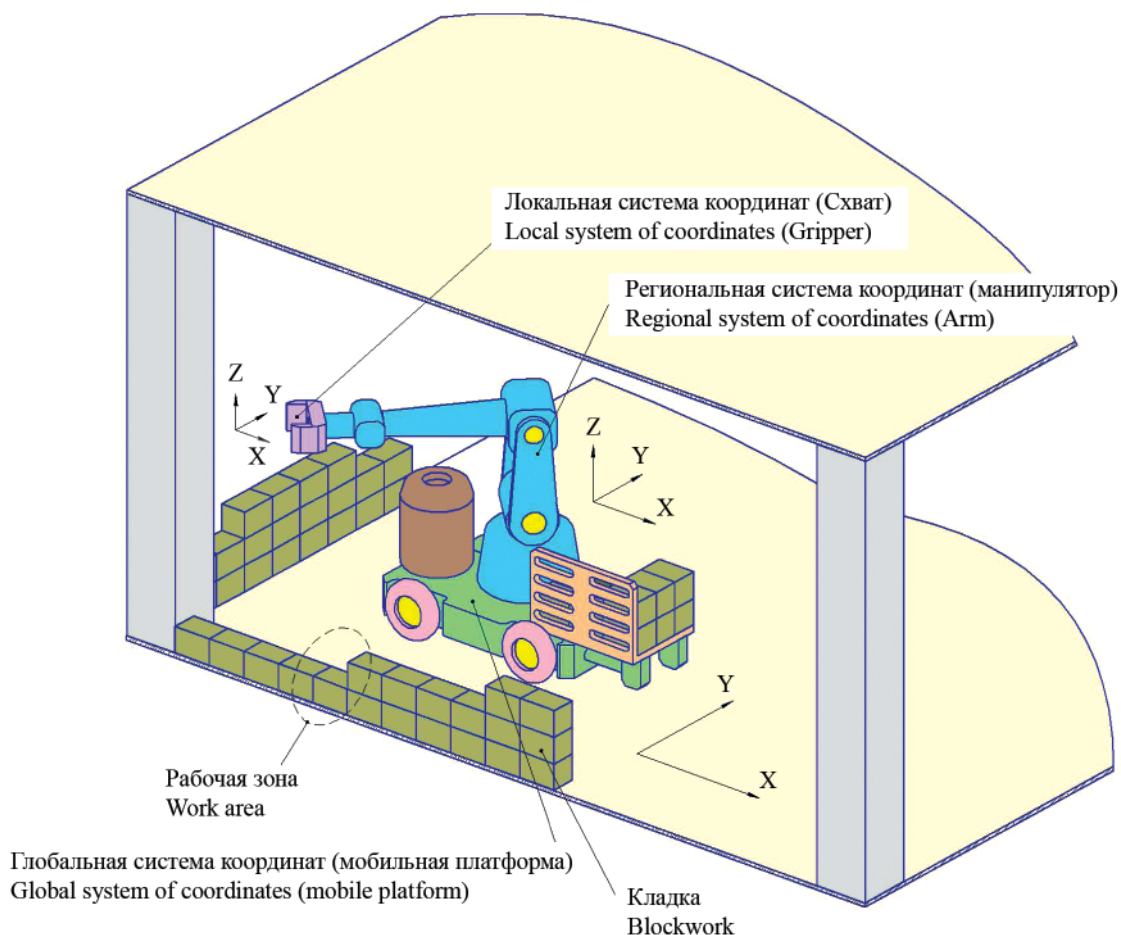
Схема функционирования РТК на площадке укладки ГБ
